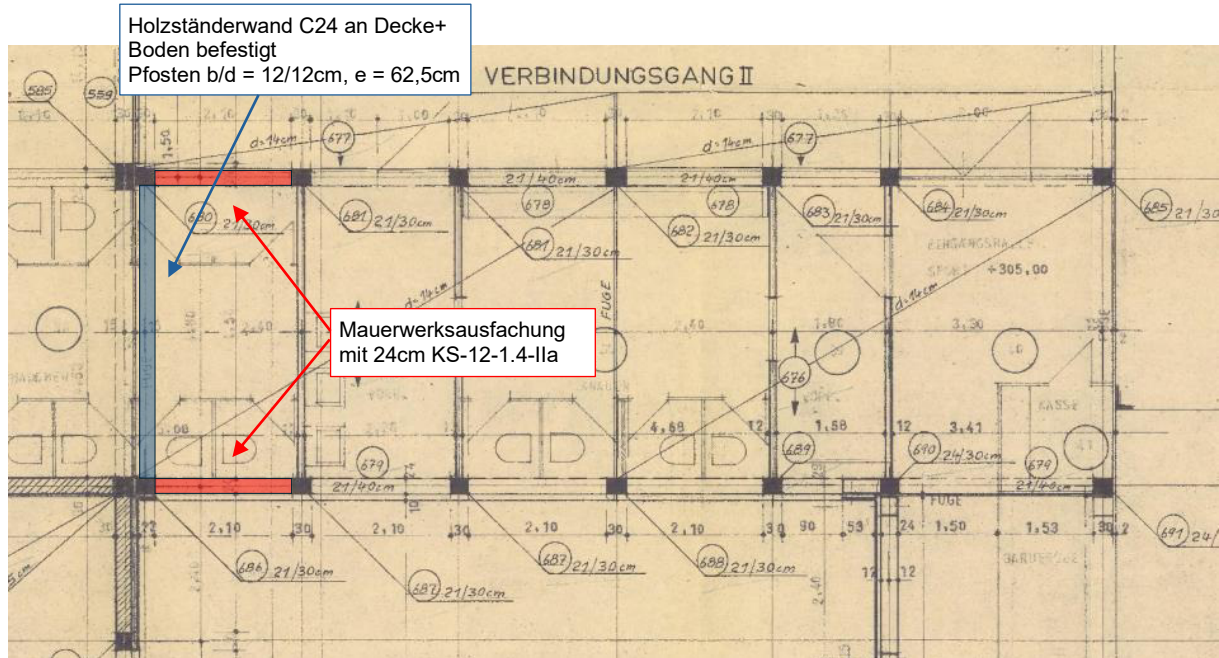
Mauerwerksausfachung Erdgeschoss
